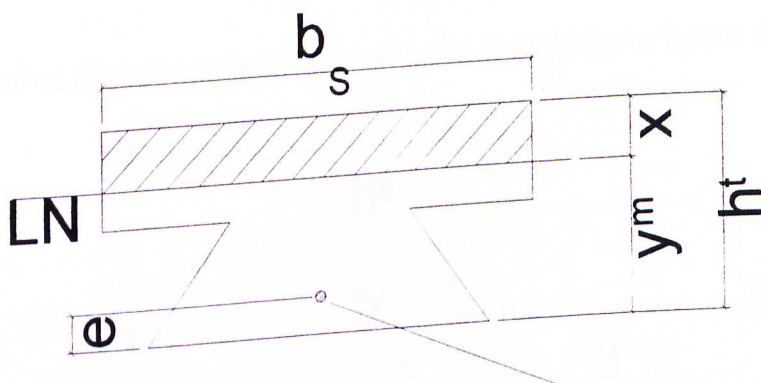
Linha neutra elástica passando acima da fôrma de aço. Dimensões utilizadas para o cálculo do momento de inércia da seção fissurada.
